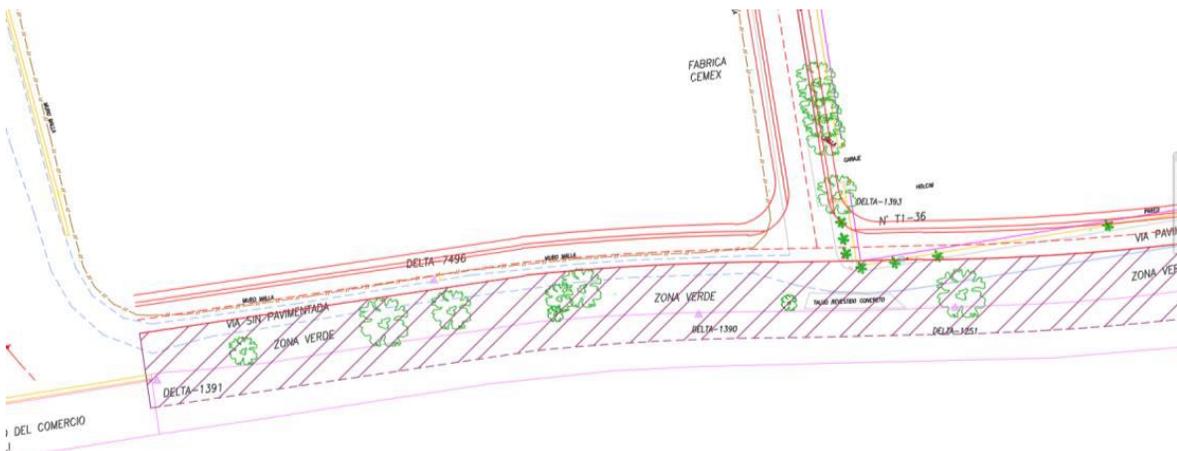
Afectación Planta de Concreto Holcim y Cemex
